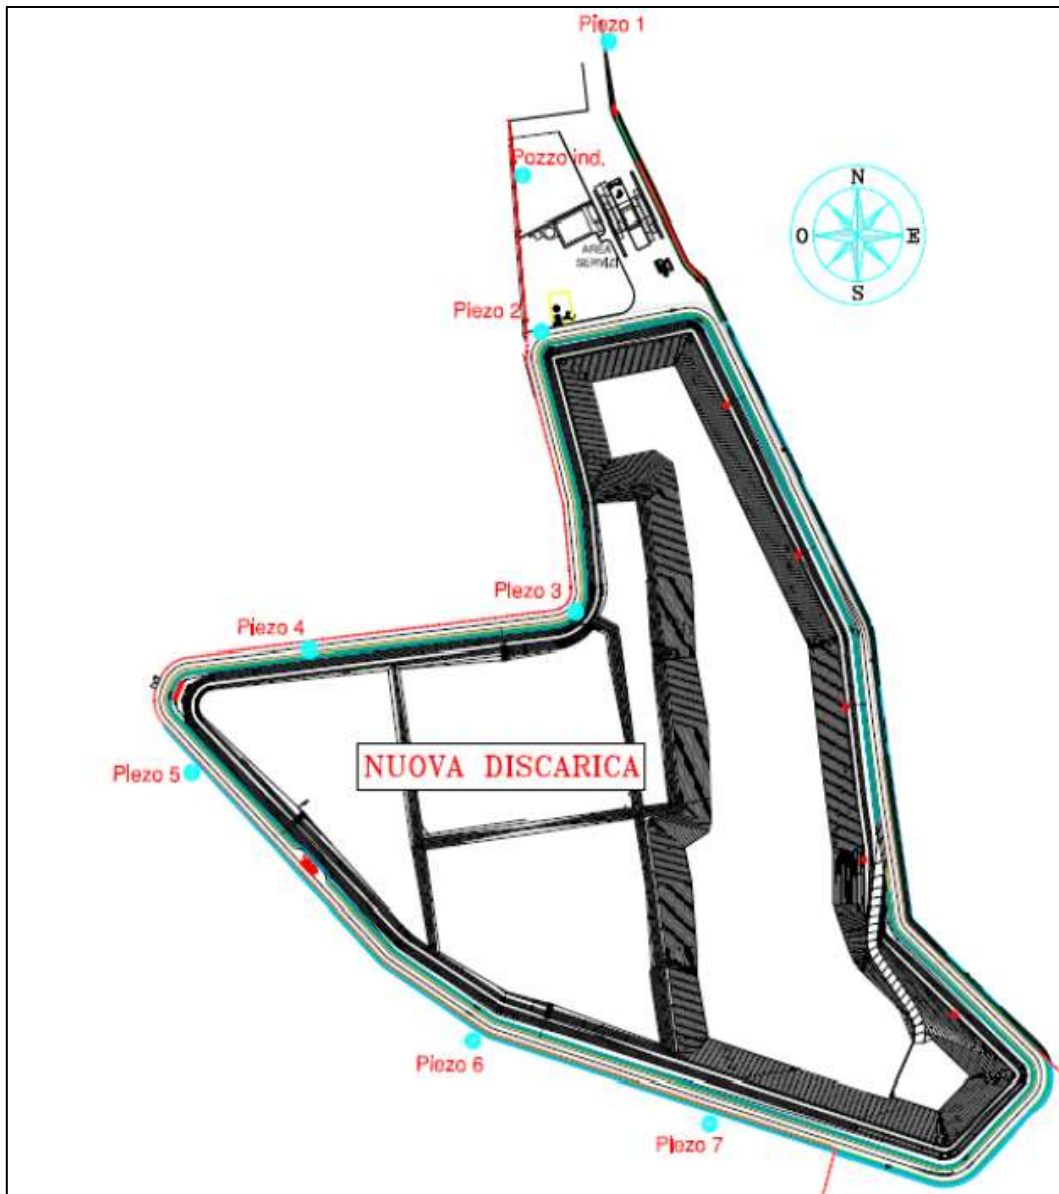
Planimetria del sito di discarica con identificazione dei piezometri
